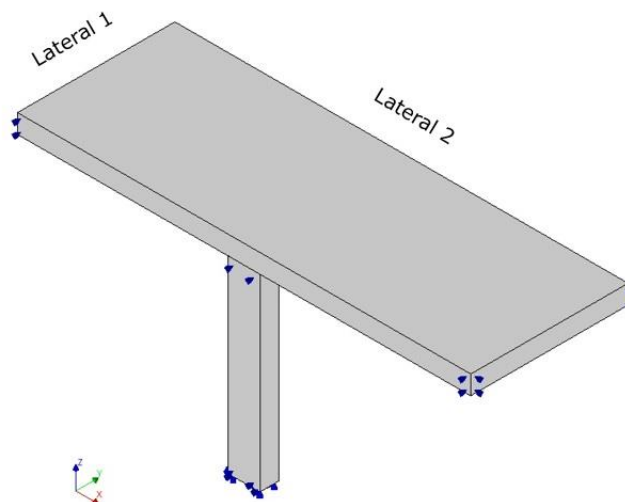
Apoios considerados para a análise da estrutura sob carregamento monotonicamente crescente e para a análise em serviço da estrutura não restringida.
